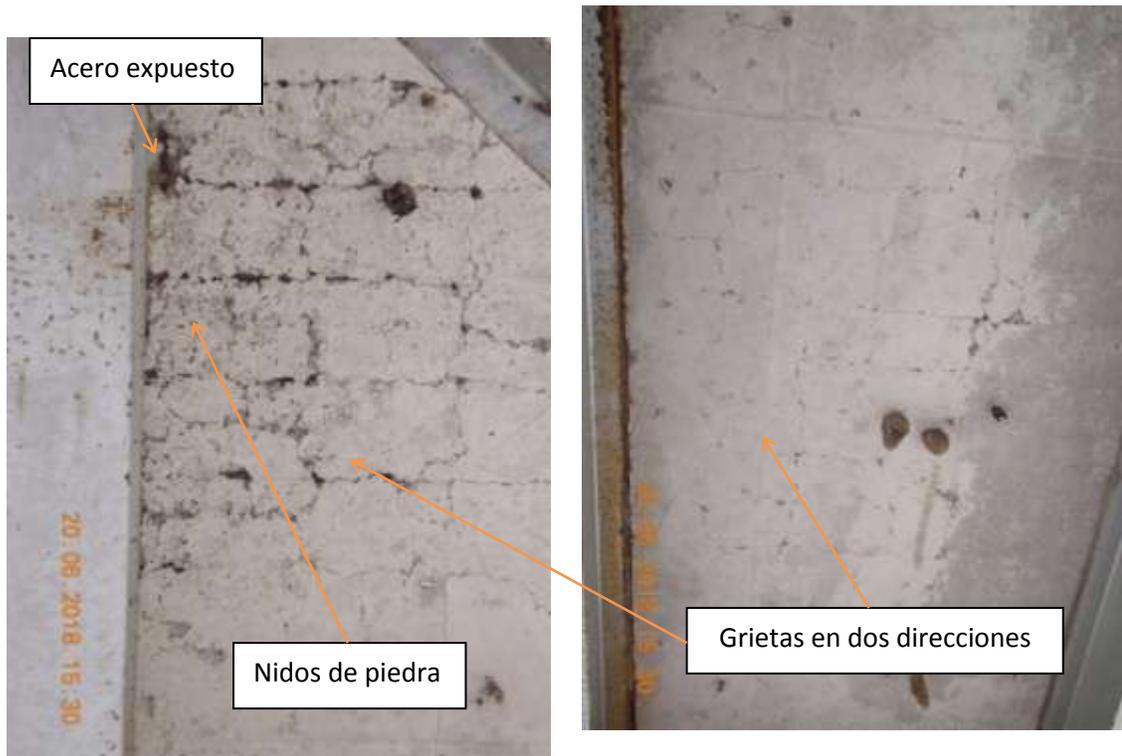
Puente sobre río Estrella. Nidos de piedra, agrietamiento en dos direcciones y acero expuesto observables en la superficie inferior de la losa.
